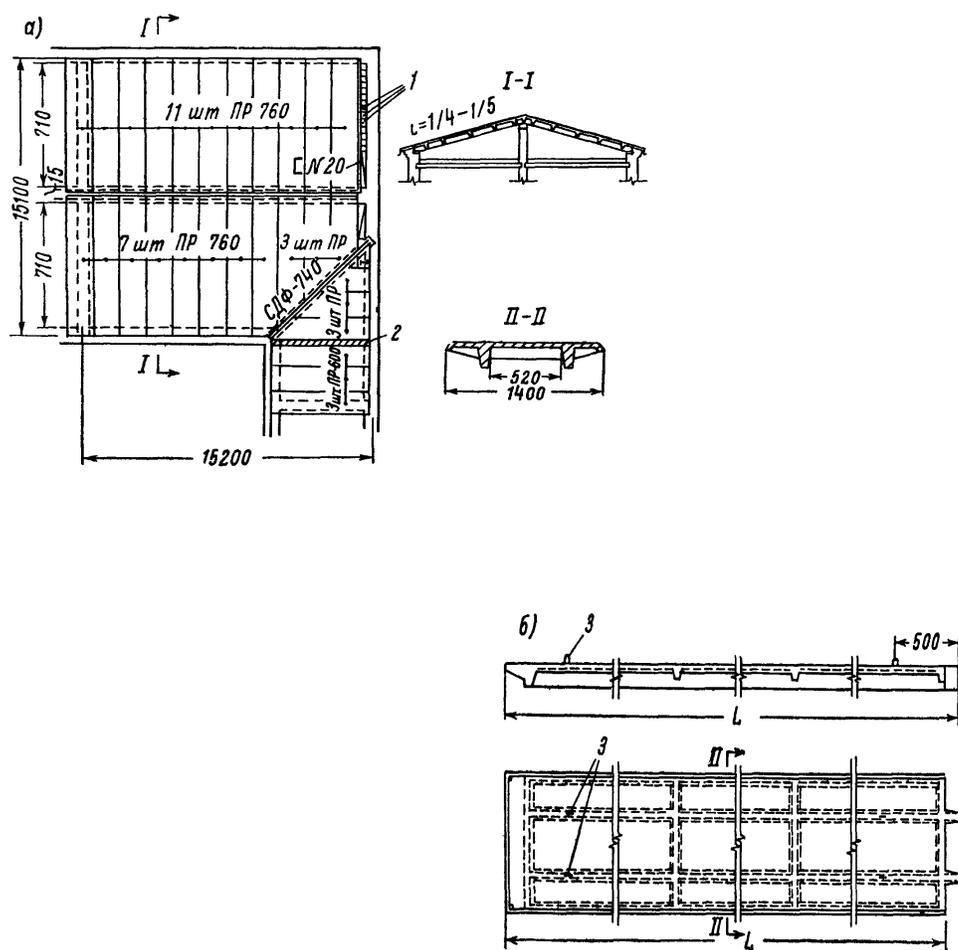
Сборная крыша из предварительно напряженных железобетонных панелей ПР
